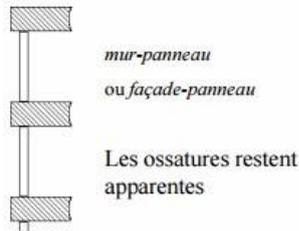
Mur panneau ou façade panneau _ Source : CERTU
